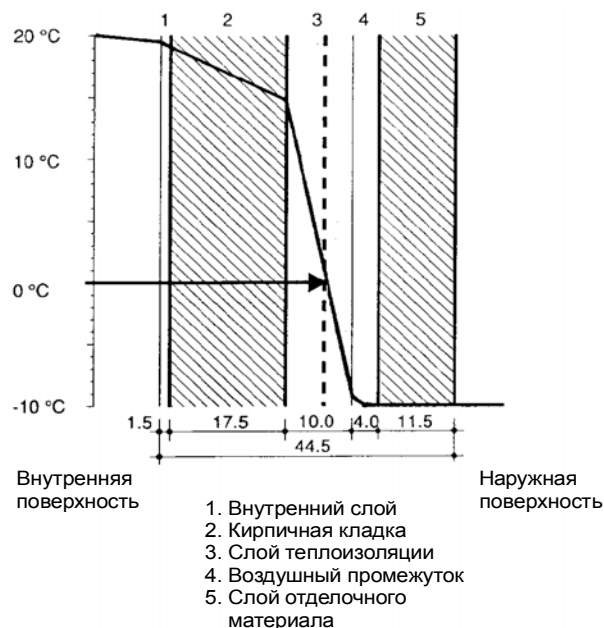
Конструкция двухслойной стены с наружным слоем, защищающим теплоизоляцию
